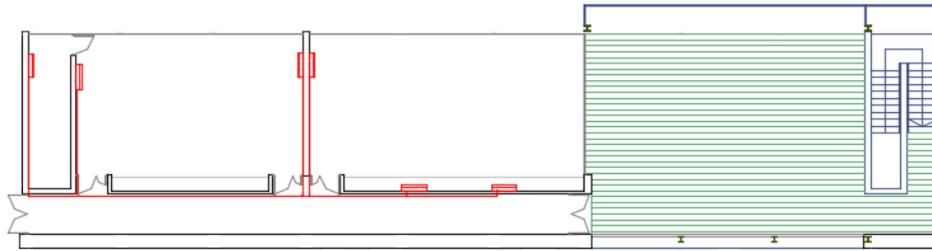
Croquis de la instalación de climatización, Edificio 5 Primera Planta
